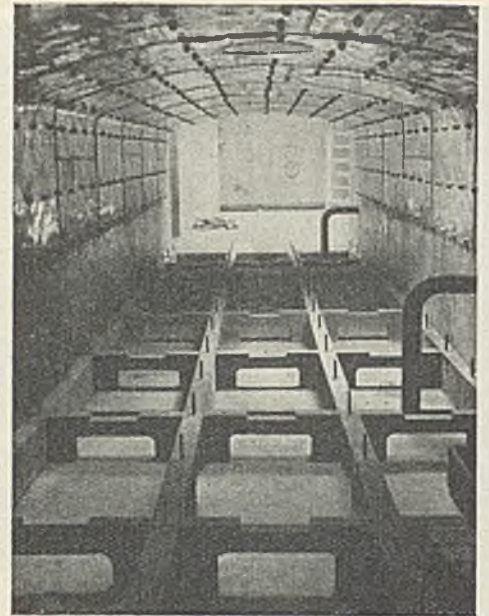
Blick in eine Kammer der Vorbelüftungsanlage.
